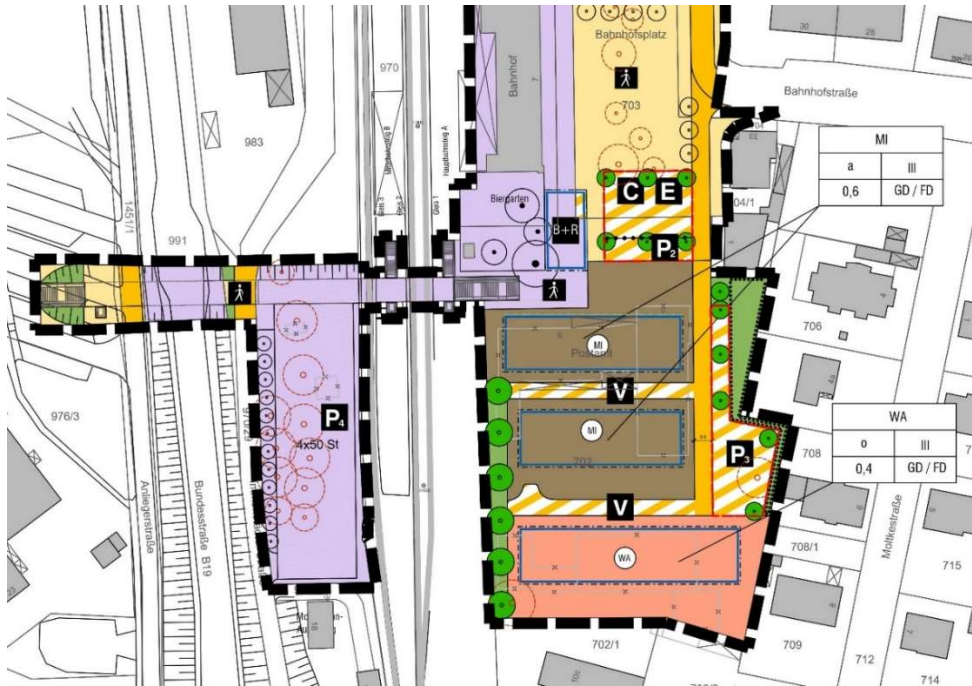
Ausschnitt Planzeichnung Bebauungsplan „Bahnhofsumfeld“ vom 29.03.2012 [b]
